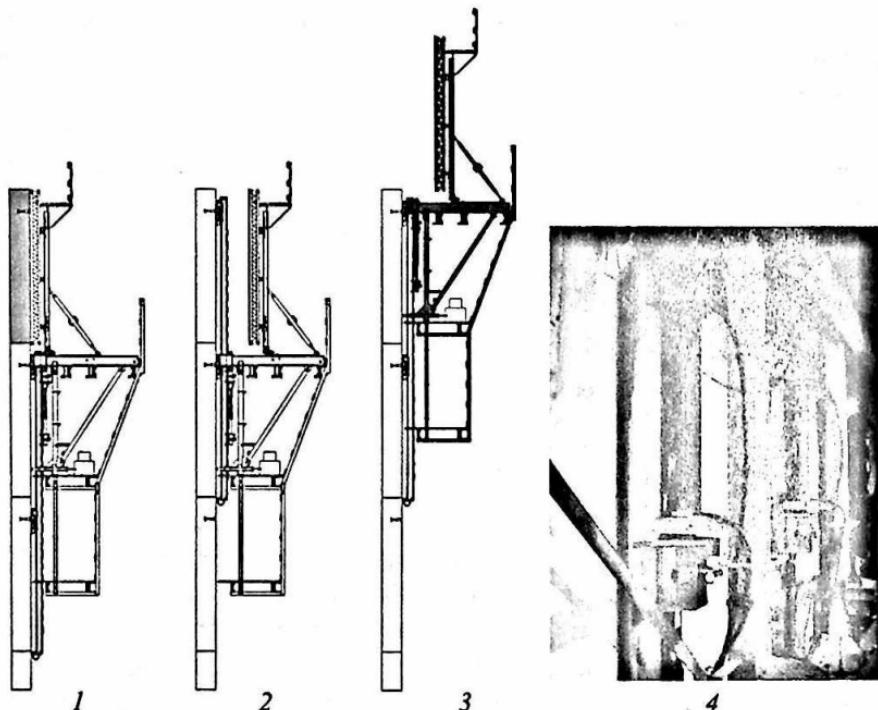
Автоматизированная система подъемно-переставной опалубки с анкерным креплением:
